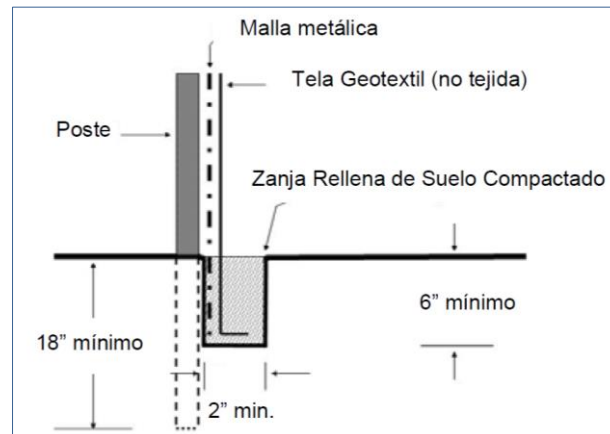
Detalles para la instalación de barreras de cieno Tipo A y B.
